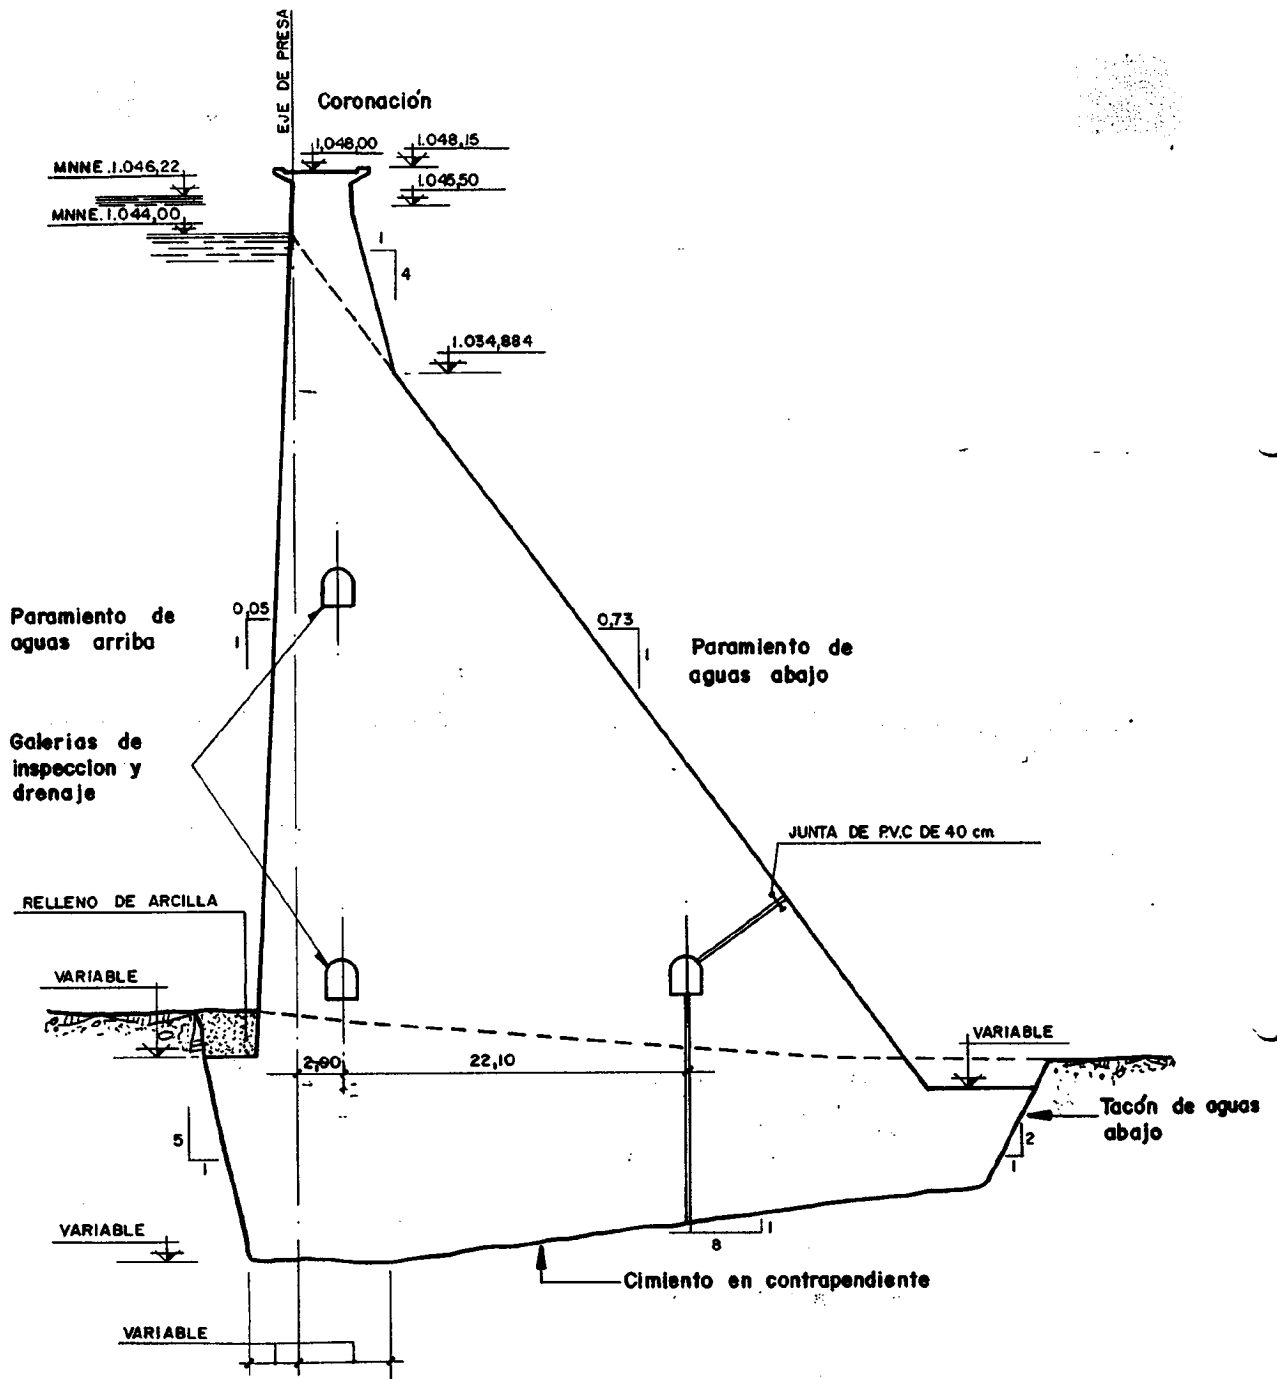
Sección tipo de presa de gravedad. Presa de Omaña. León.
